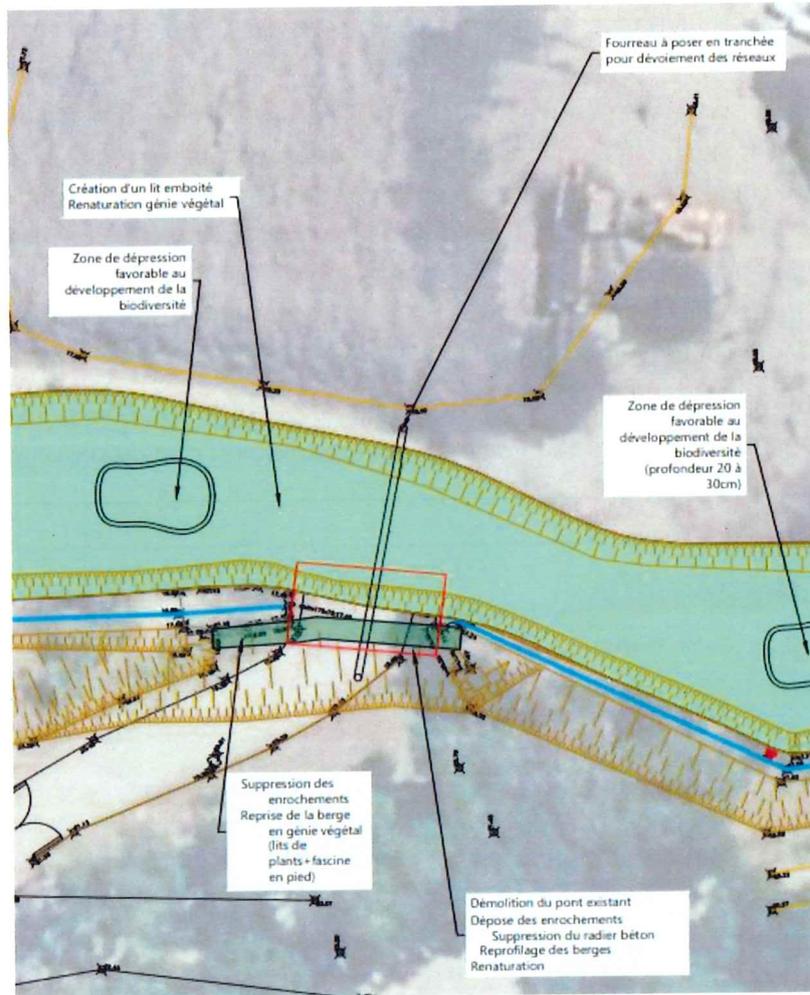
Vue en plan des aménagements au droit de l'ouvrage hydraulique intermédiaire
